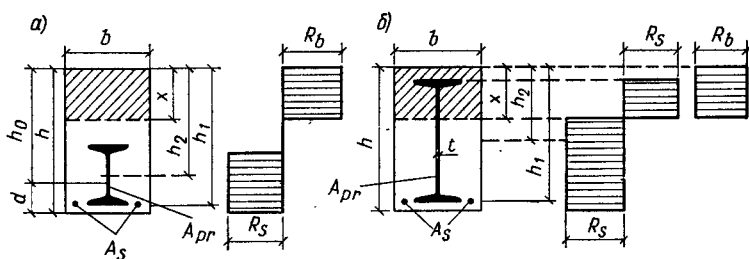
Прямоугольные поперечные сечения изгибаемых элементов с жесткой арматурой
